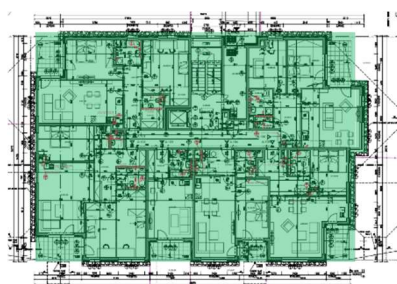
Půdorys a řez 1.PP; zdroj: [16]
